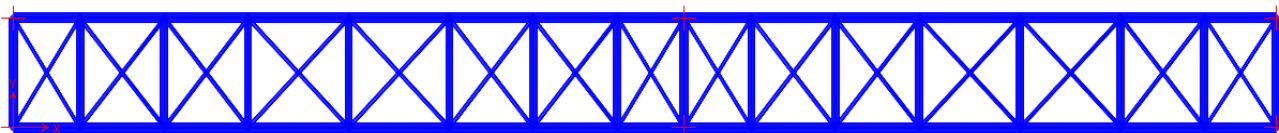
Modello di calcolo E.F. – Vista in pianta
